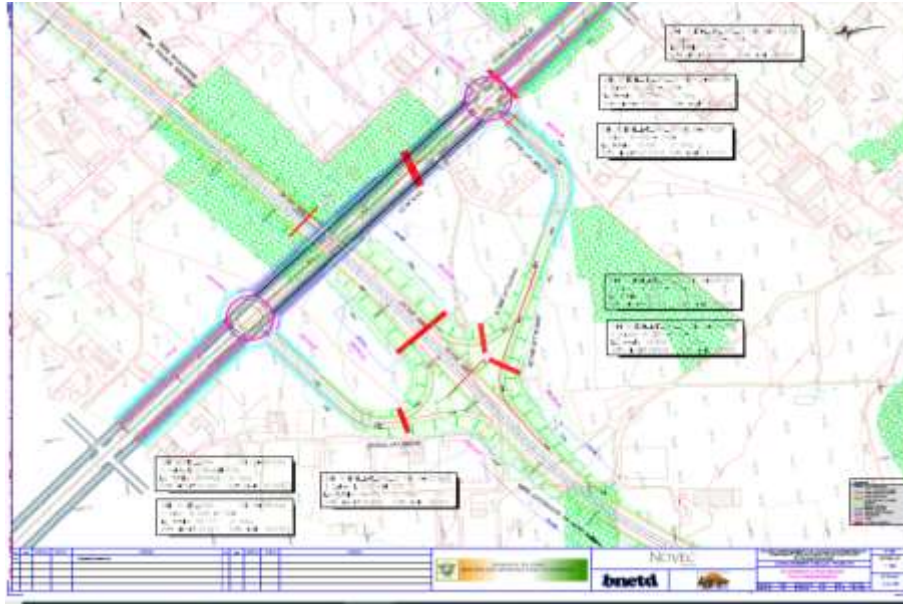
Plan d'aménagement de l'échangeur au niveau du croisement avec le Boulevard Latrille
